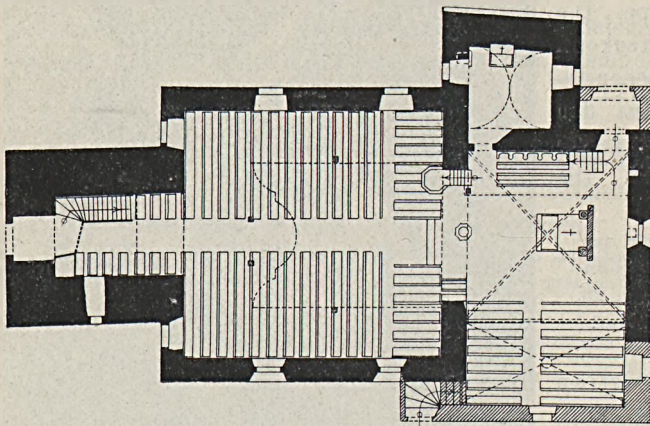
Oberullersdorf, Grundriß der Kirche.
